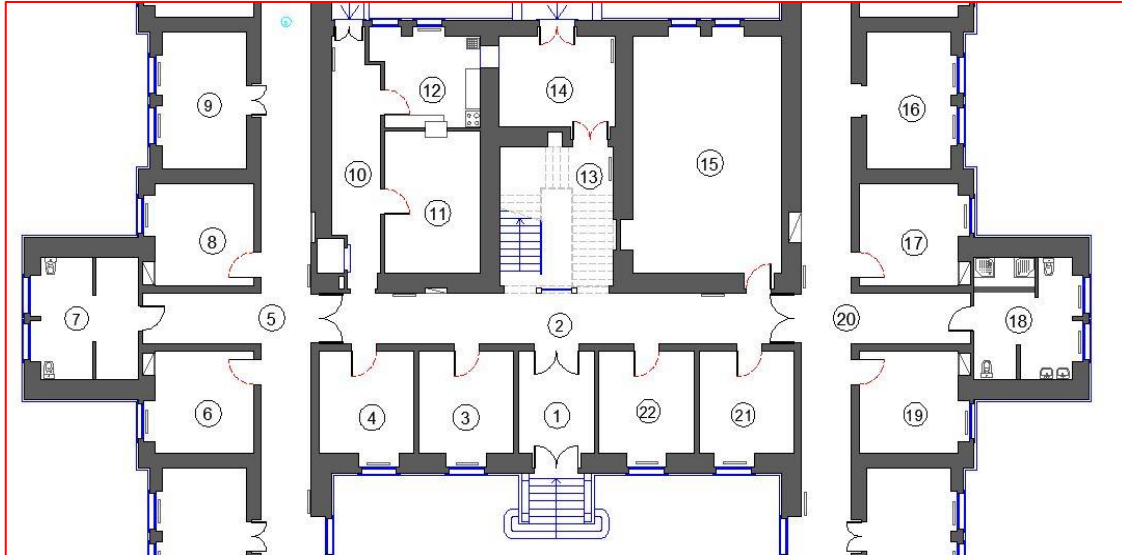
Planta do piso 0 do núcleo central do Pavilhão 16A.
